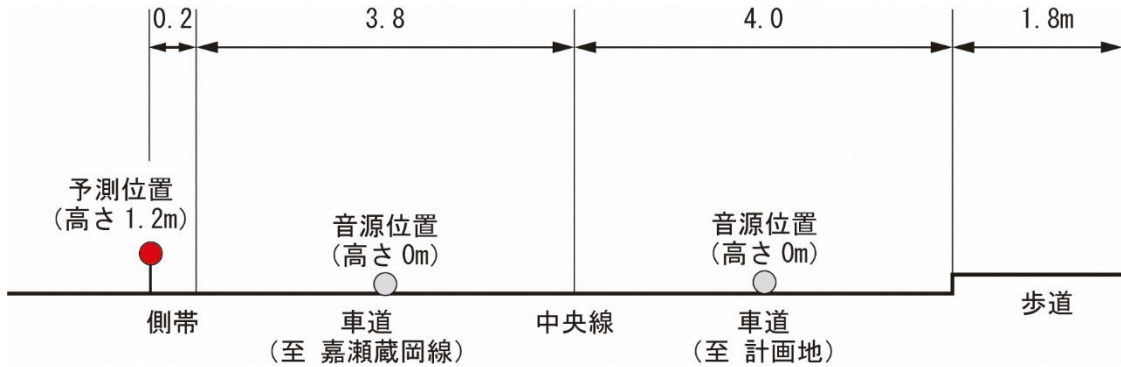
(1) 道路断面図 (No.1 : 南 6-79 号線沿道)
